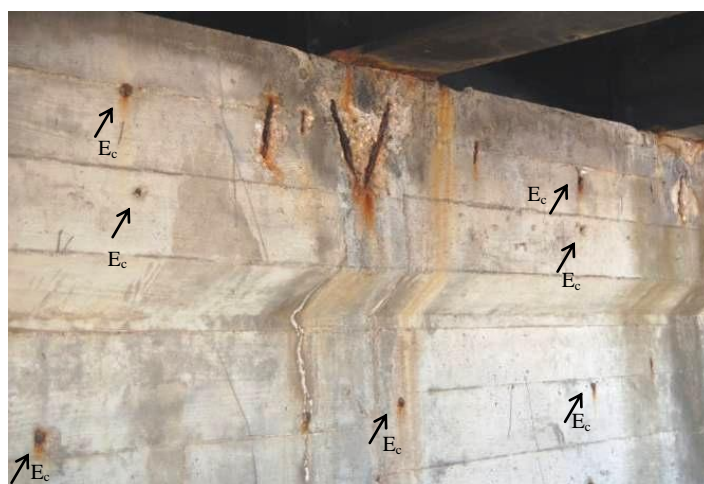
Extremidade corroída dos espaçadores metálicos no pilar parede (E_c)
